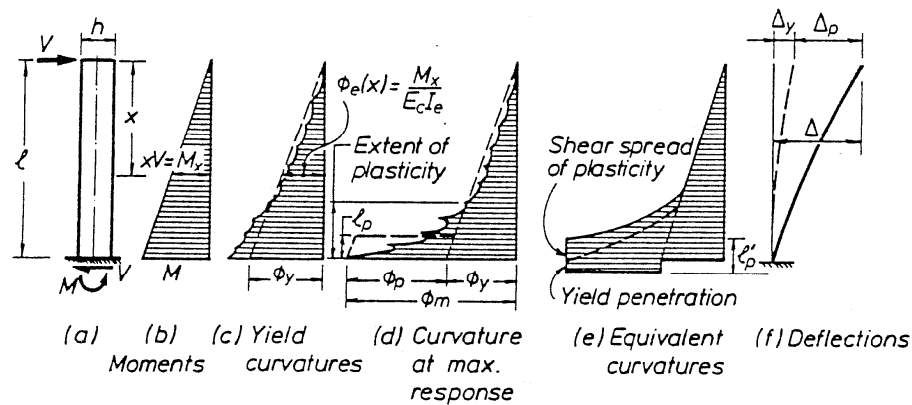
Diagramele de moment și curbura, precum și deformațiile unei console prismatice din beton armat (Paulay și Priestley, 1992).
